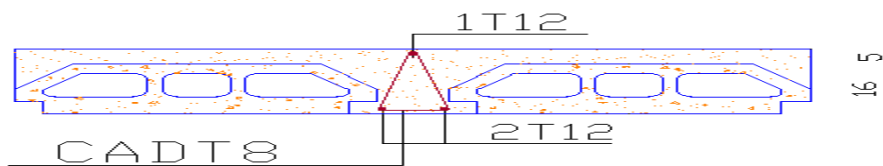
Schéma de ferrailage des poutrelles d'étage courant en travée.
